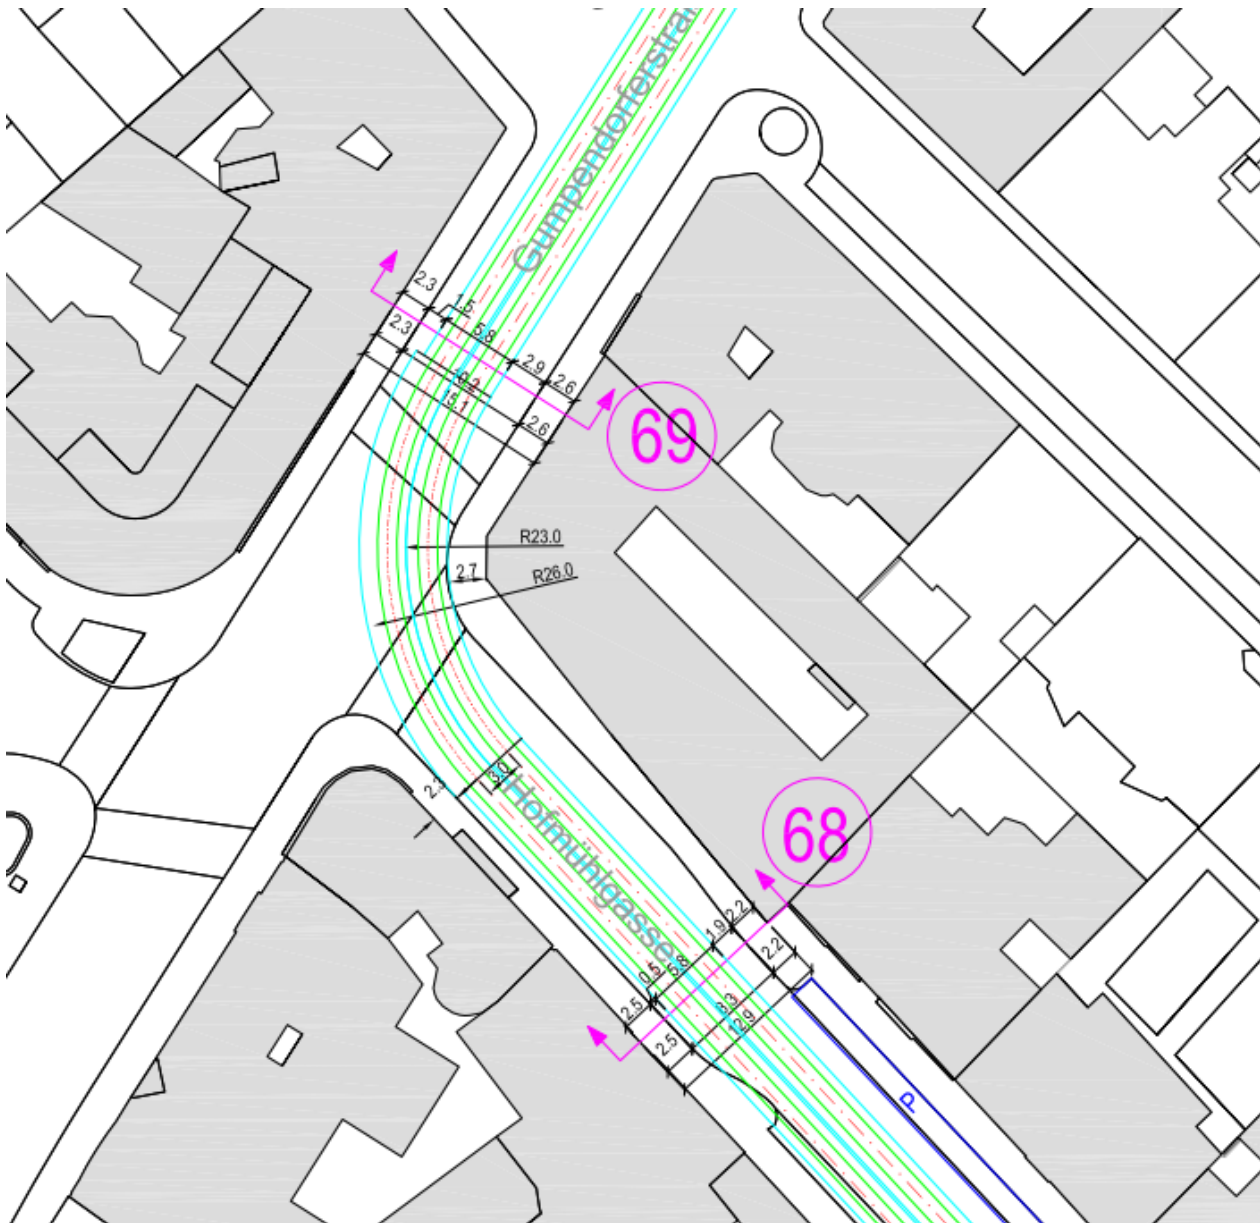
Lageplan Gumpendorfer Straße / Hofmühlgasse
